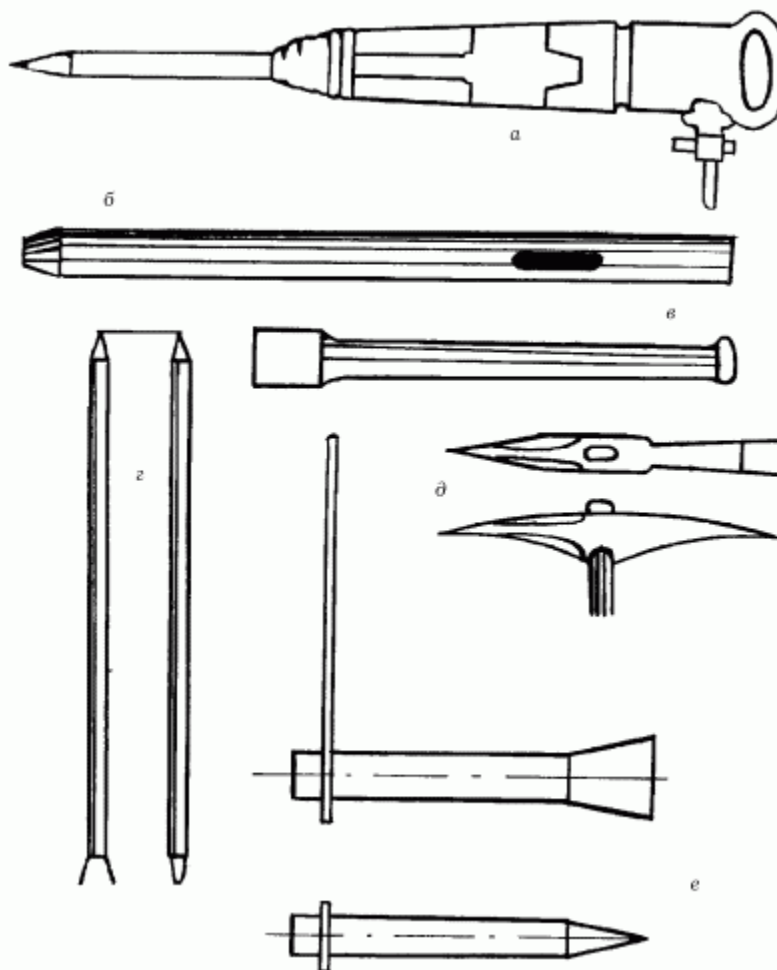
Инструменты для разборки каменной кладки и пробивки отверстий: а – пневматический молоток; б – шлямбур; в – скарпель; г – лом; д – кирка; е – клин.
